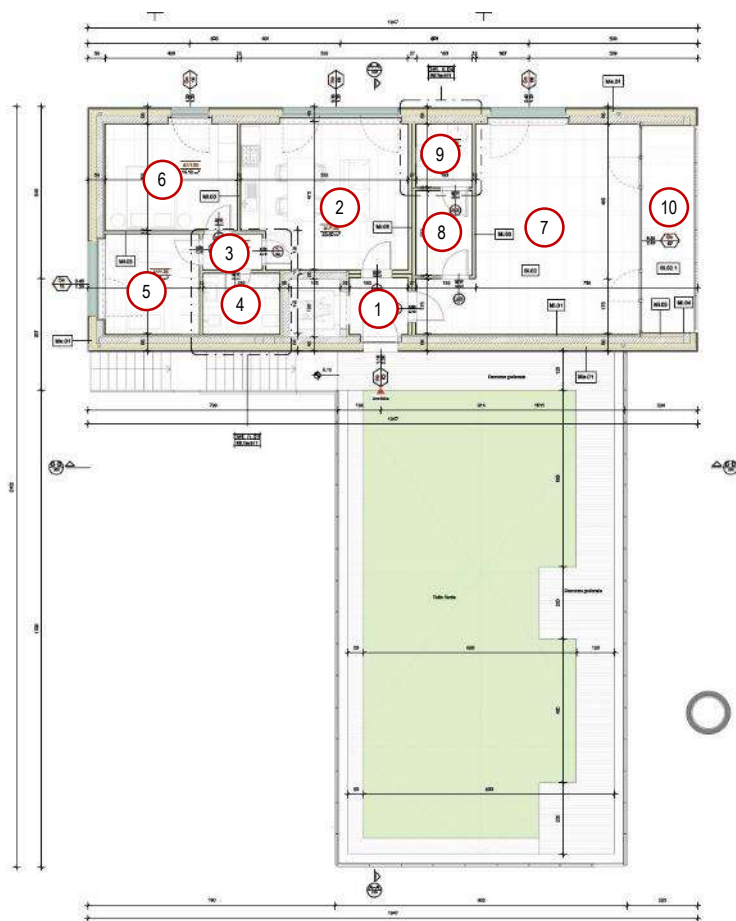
progetto esecutivo – pianta piano primo – elaborato 307 – scala adattata
